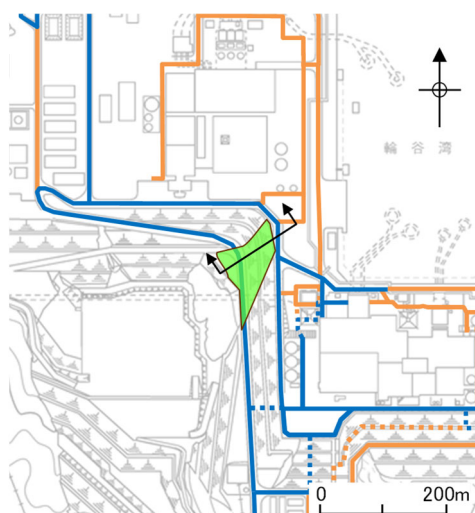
33m盤盛土斜面の断面位置図
